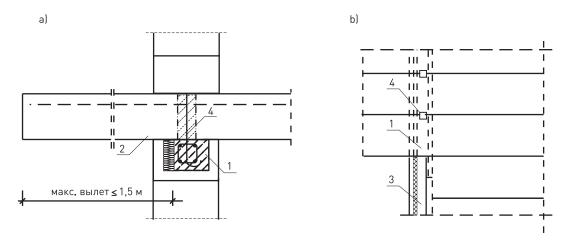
Балкон из плит перекрытия YTONG: a) вид сбоку; b) вид сверху;
